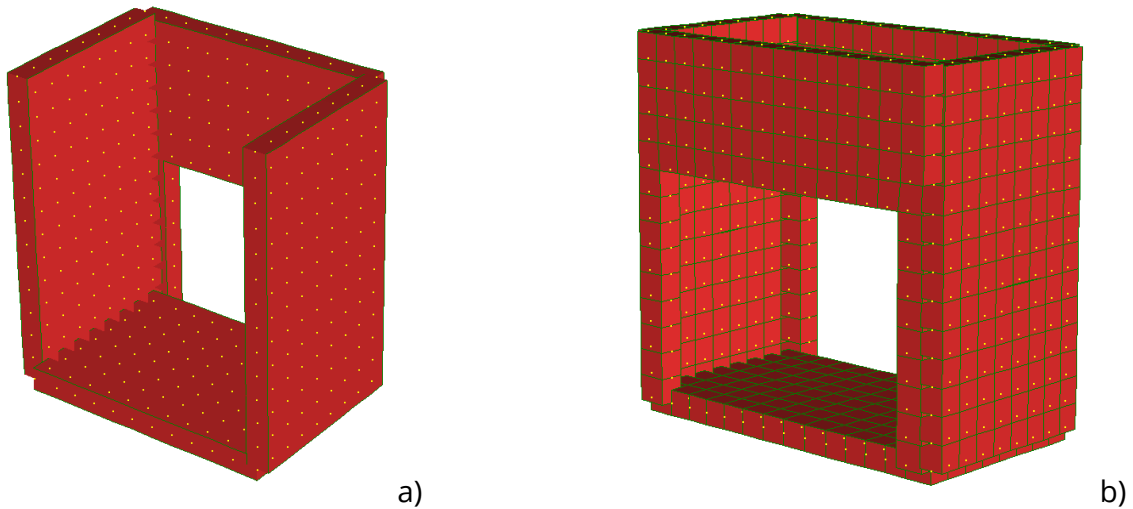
Camera di imbocco a) e pozzetto intermedio b)
